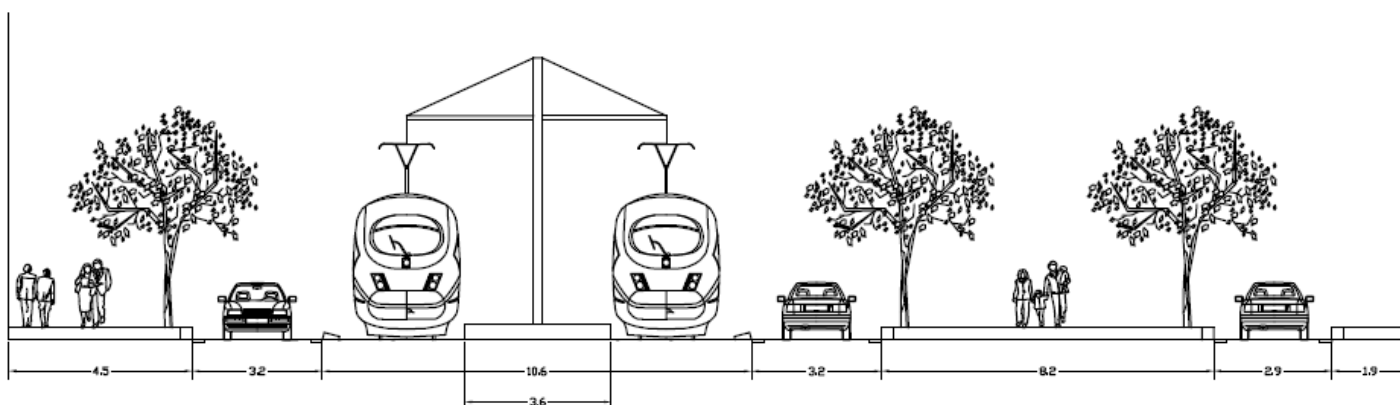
Sección de Laureà Miró con Plaza Santa Magdalena con parada de tranvía.
